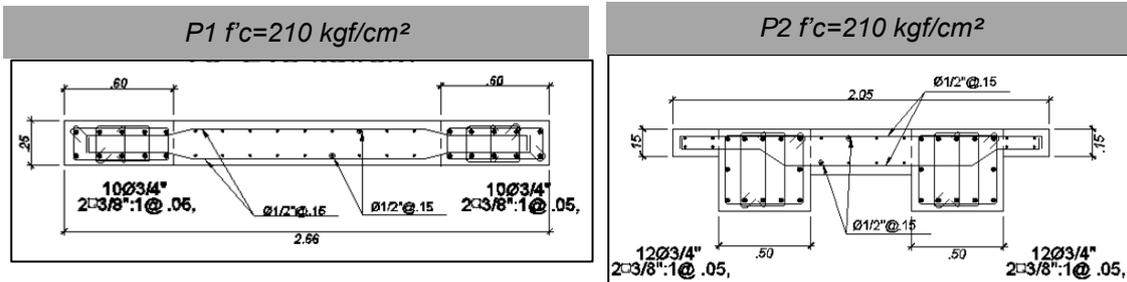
Tipos de Placas aplicas al proyecto de la IIEE Antonio Raimondi
